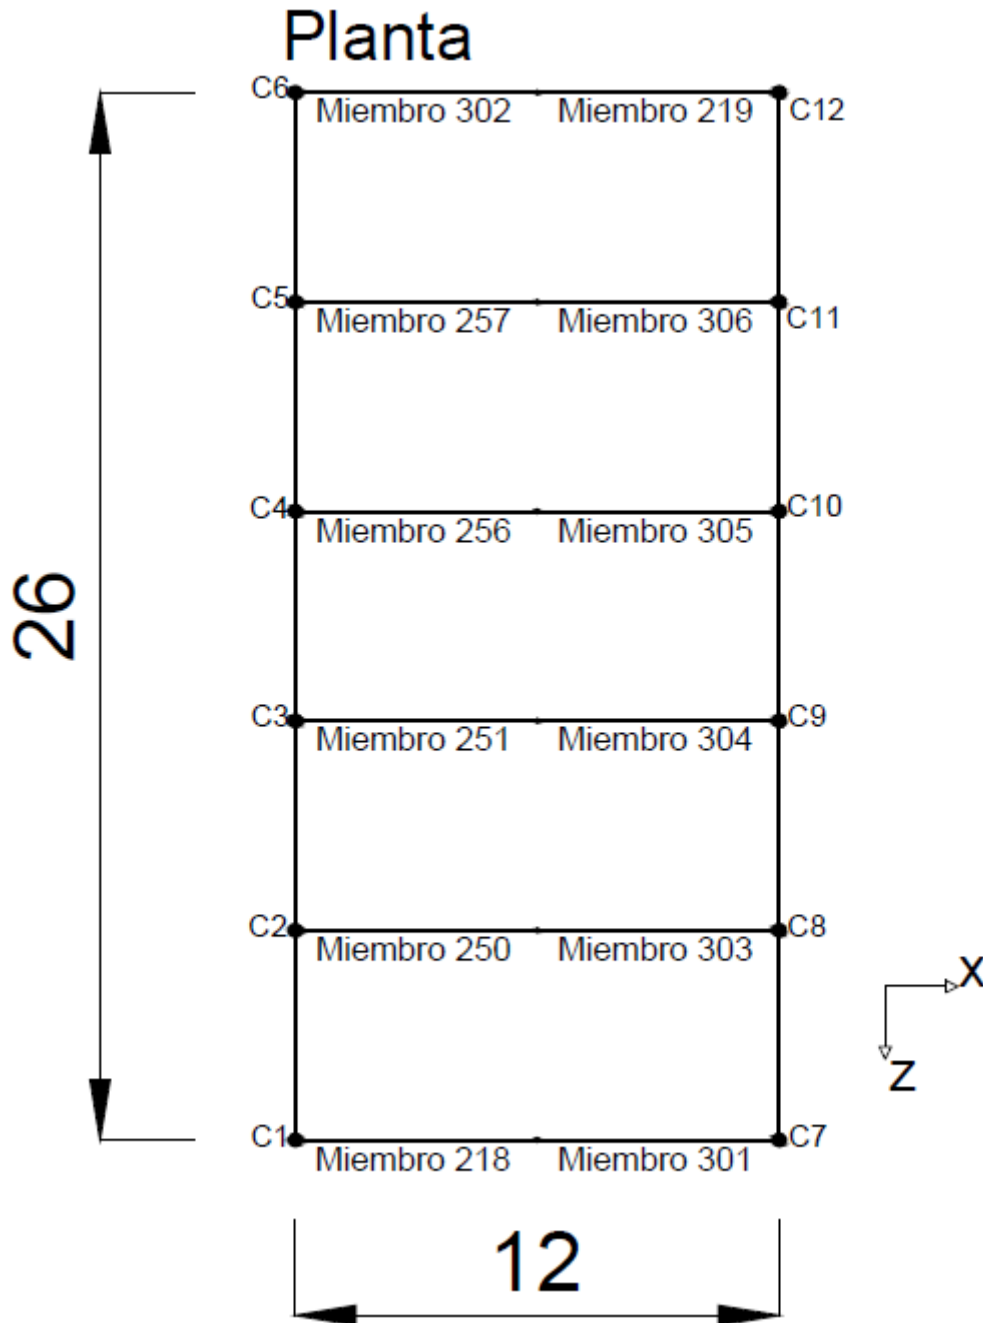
Planta de la Estructura-Montantes Referenciadas
